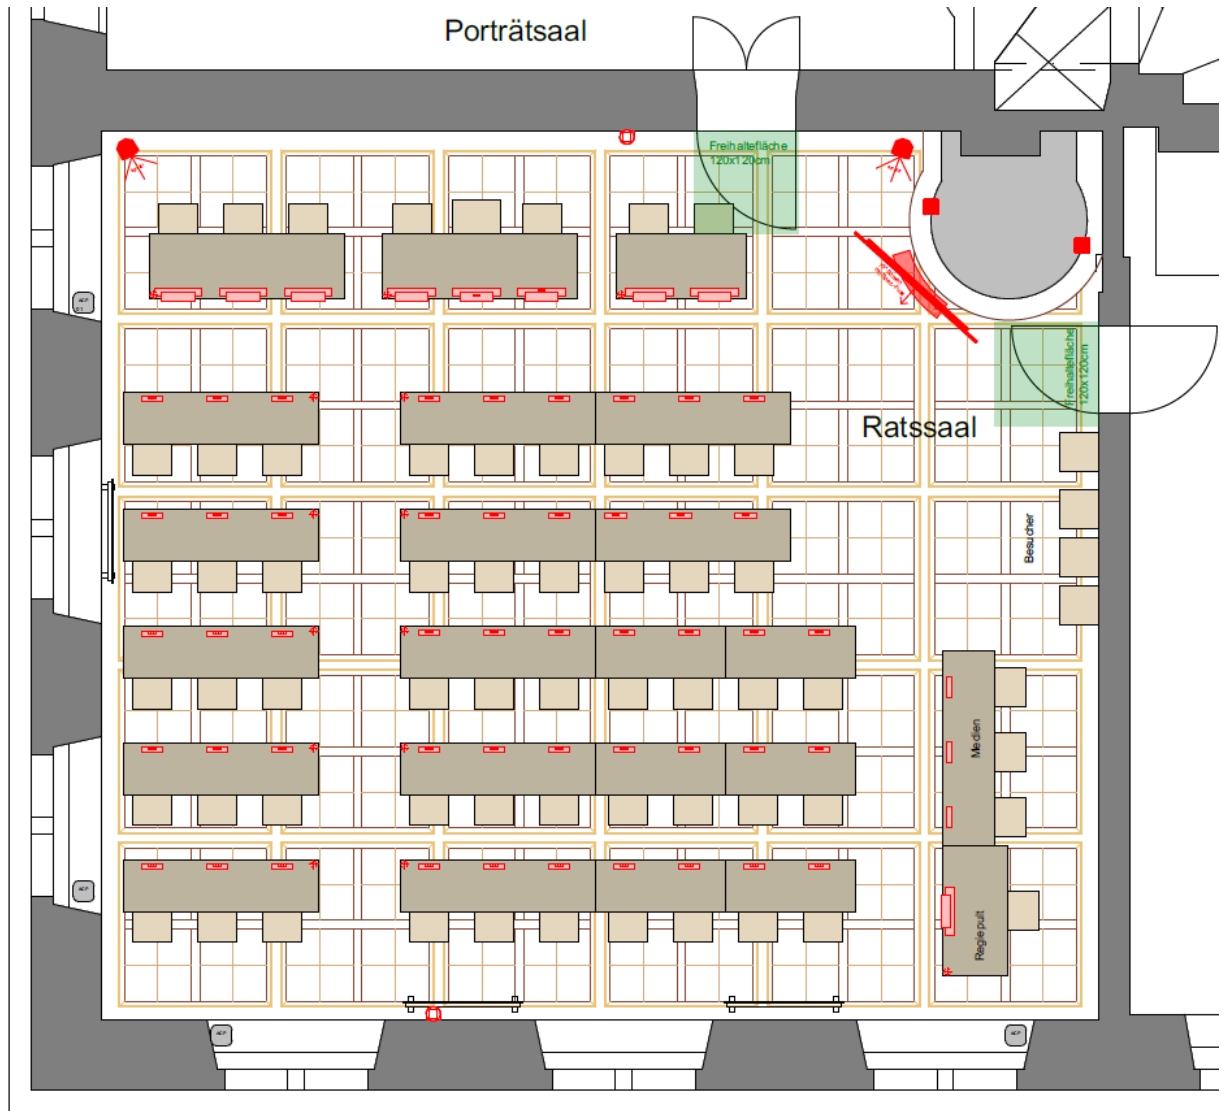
Grundriss Ratssaal / Übersicht Medientechnik
